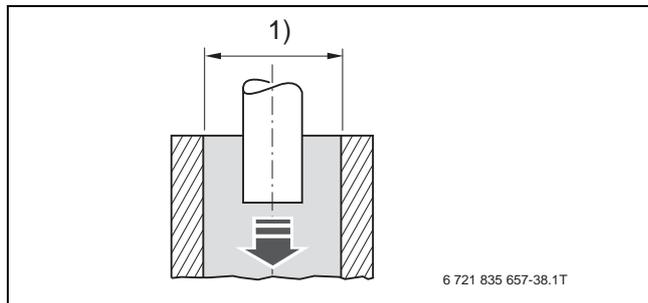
Mindestmaße des Schachtquerschnitts für die Montage der Abgasleitung für Kesselgröße ≥ 50 kW (Maße in mm)
